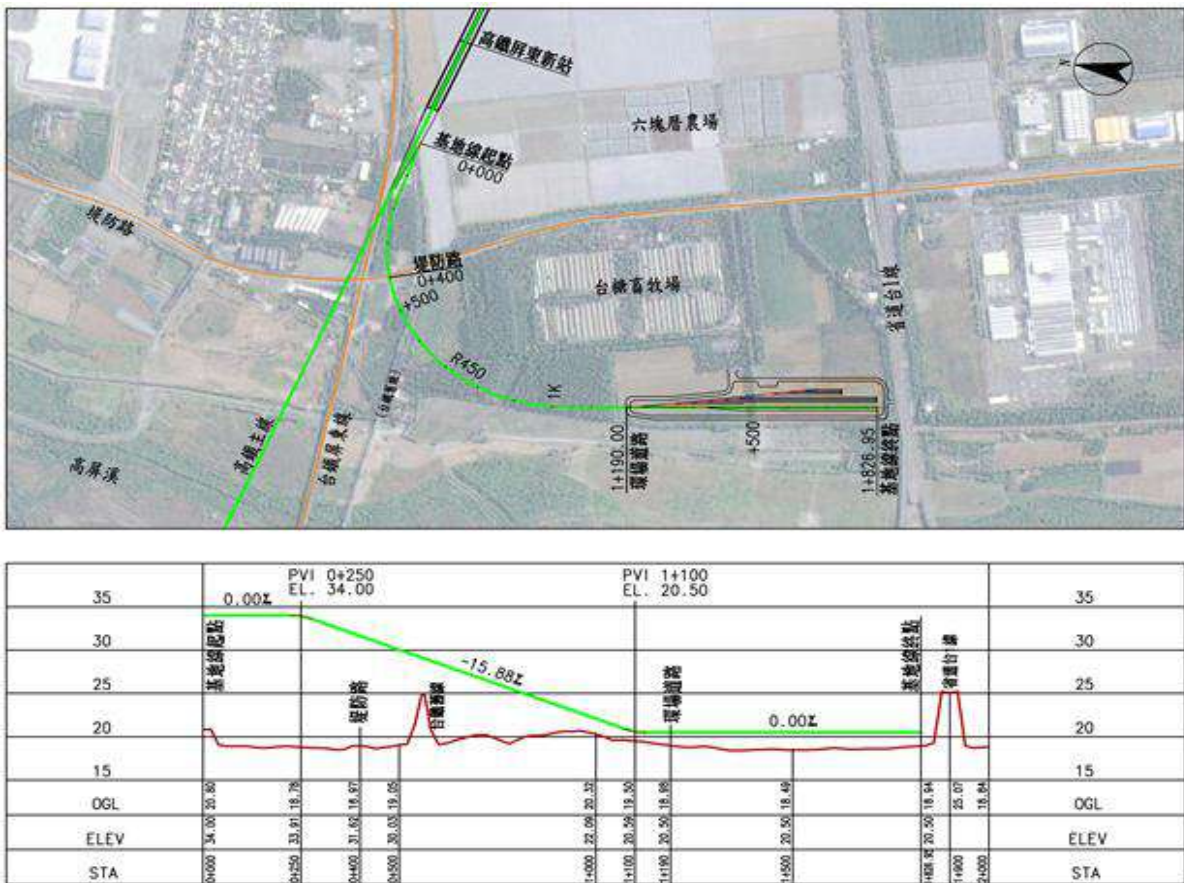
進場線及基地之平縱斷面示意圖
